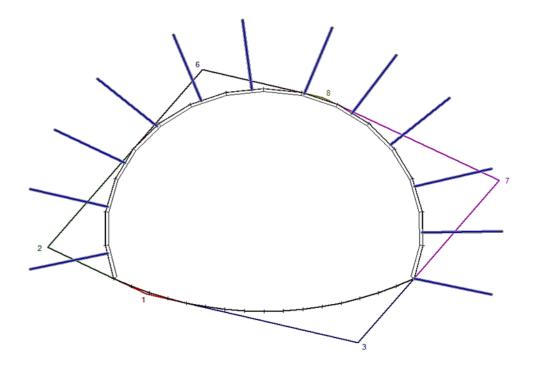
Sección del túnel con el bulonado y hormigón proyectado propuesto por Romana. Elaboración Propia
